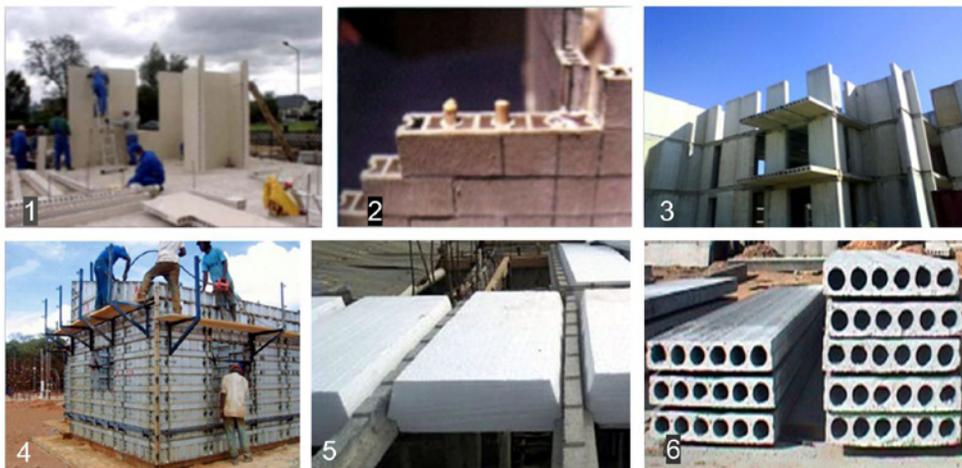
Muestra de sistemas constructivos analizados en este trabajo: 1) Panelería ligera a base de EPS, 2) Muros de bloques, 3) Sistema Losa Hueca (LH), 4) Sistema FORSA, 5) Sistema de Vigueta y bovedilla de Poliestireno expandido, 6) Losa Spiroll. Fuente: autores.
